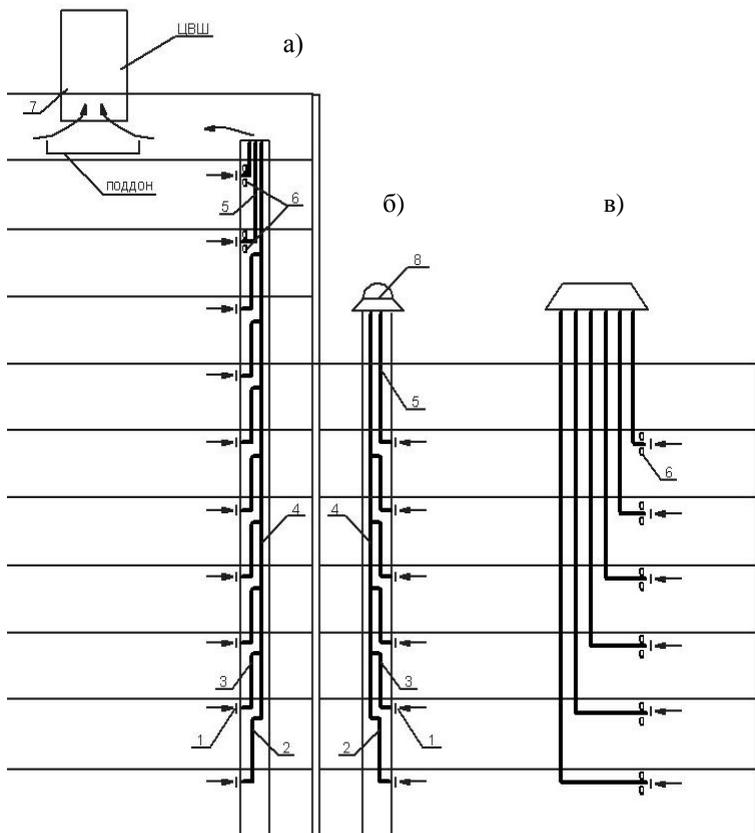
Схема вытяжной естественной и механической вентиляции для многоэтажных (высотных) зданий:
